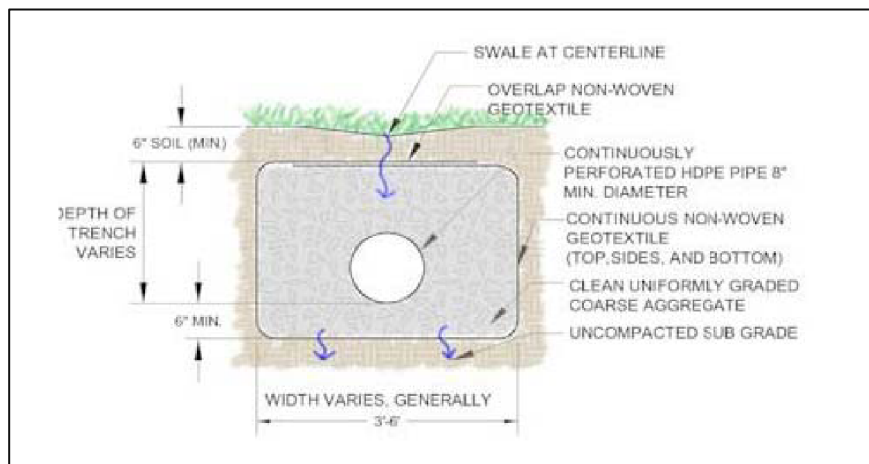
trincheras de infiltración con conductas (fuente: DEP,2006)
